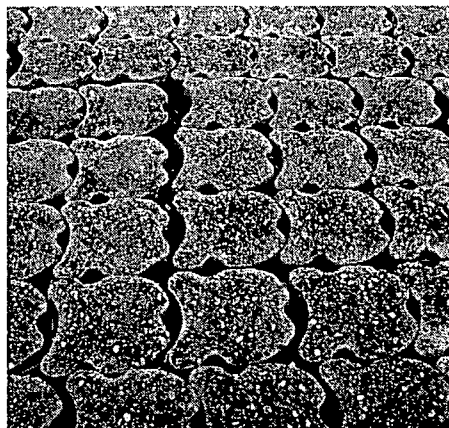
open zetting tussen betonzuilen (dijkpaal 222+65m)
